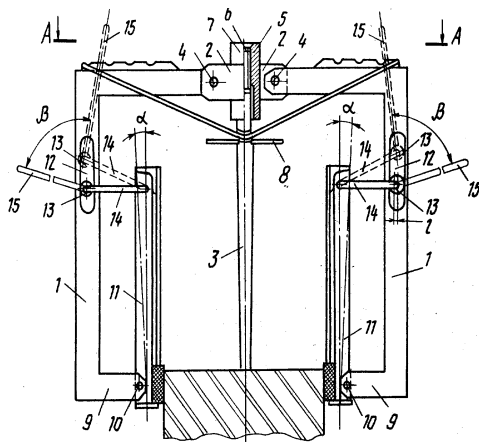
Опалубка для возведения бетонных и железобетонных сооружений [18]: 1 - Г-образный элемент рамы; 2 - пластина рамы; 3 - выдвижная колонна; 4 - шарнир; 5 - стакан; 6 - нарезная резьба стакана; 7 - нарезная резьба колонны; 8 - поворотная рукоятка колонны; 9 - кронштейн; 10 - шарнир; 11 - опалубочный щит; 12 - прорезь; 13 - эксцентрик; 14 - плечо, шарнирно соединенное с эксцентриком (13) и жестко с плечём (15); 15 - плечё двух плечевого рычага и одновременно монтажная петля; 17 - растяжка, соединяющая выдвижную колонну (3) с Г-образными элементами рамы.
